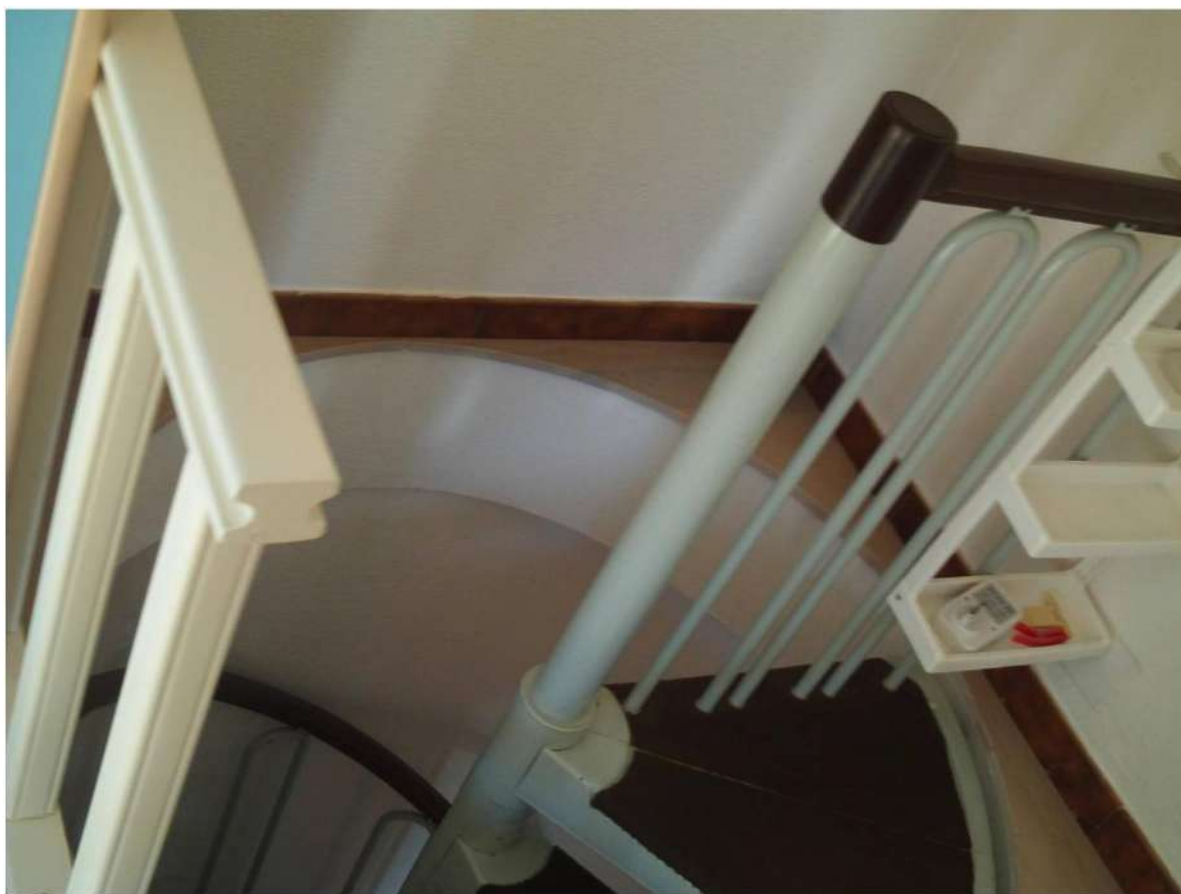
Foto scala a chiocciola di collegamento tra i piani
